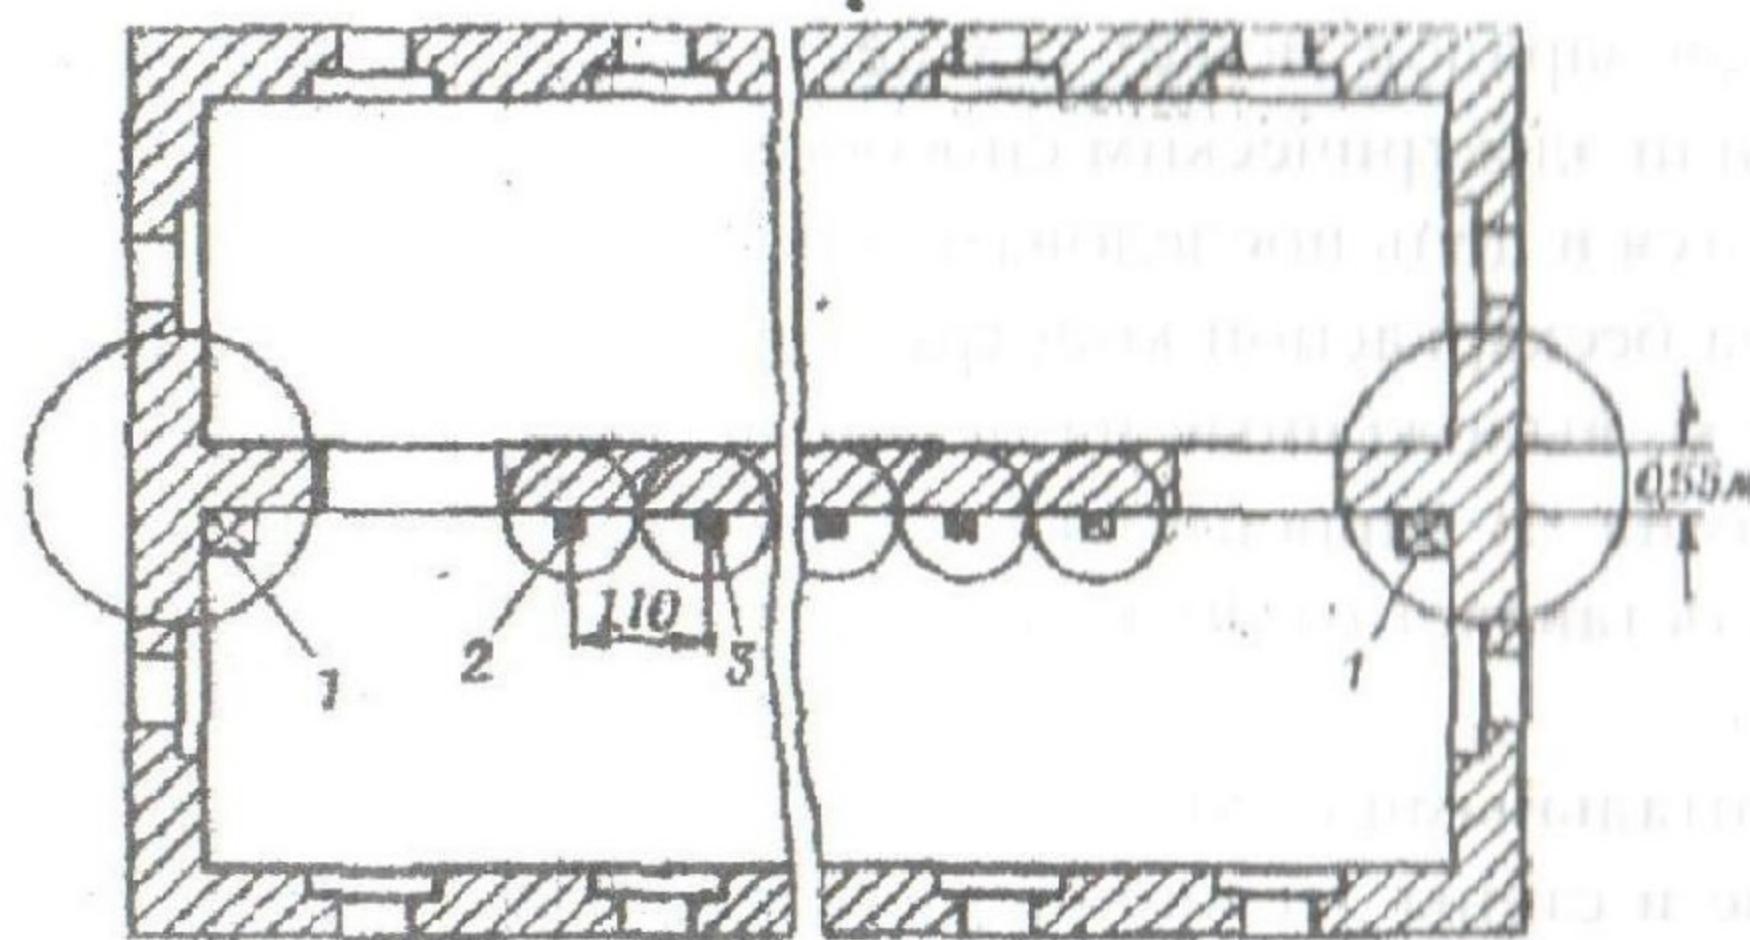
Повреждение здания подрыванием внутренней капитальной стены: 1, 2, 3 – заряды
